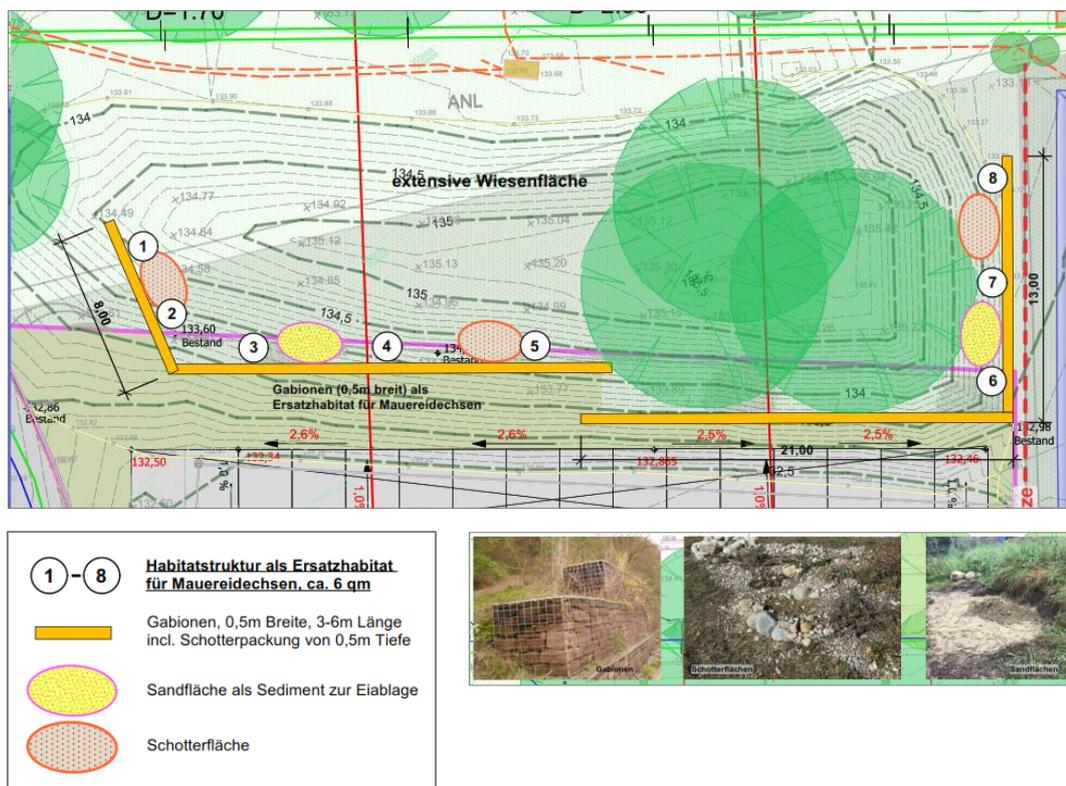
Lageplan mit den Ersatzhabitaten für Mauereidechsen (Quelle: Baden-Baden, FG Park und Garten, November 2023)
